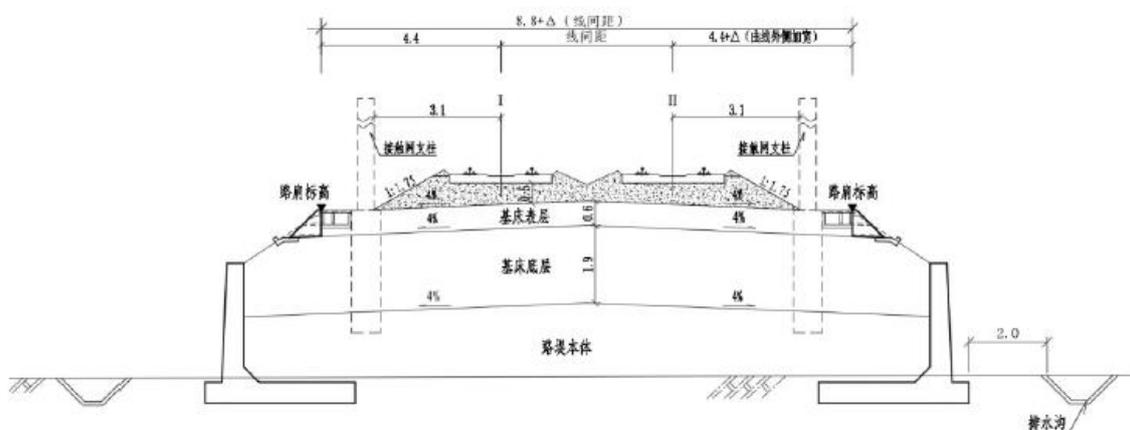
有砟轨道双线路堤标准横断面图 砟轨道双线路堤标准横断面图
